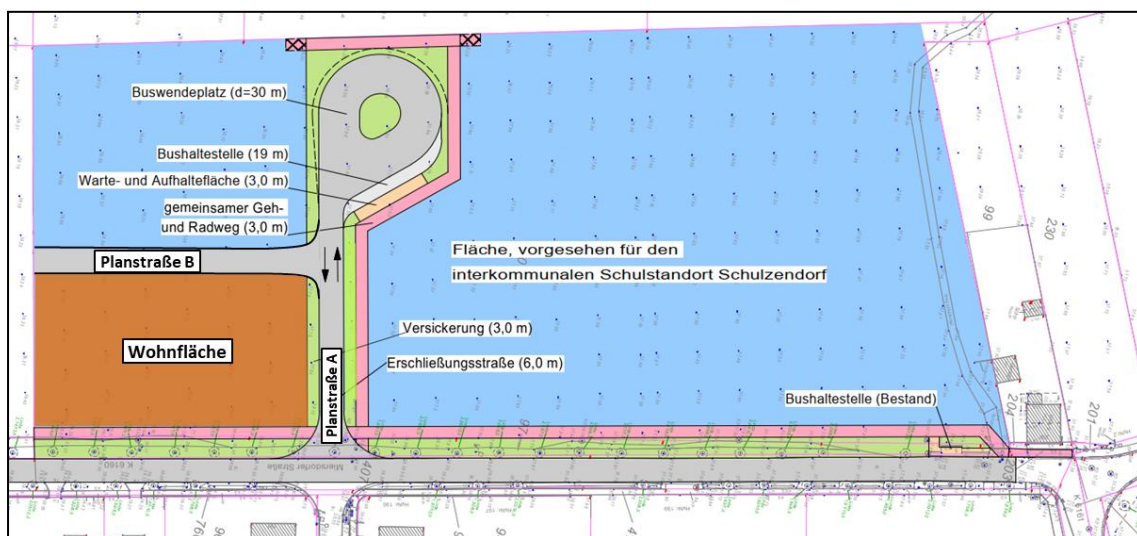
Schulbus-Haltestellen in Planstraße A
